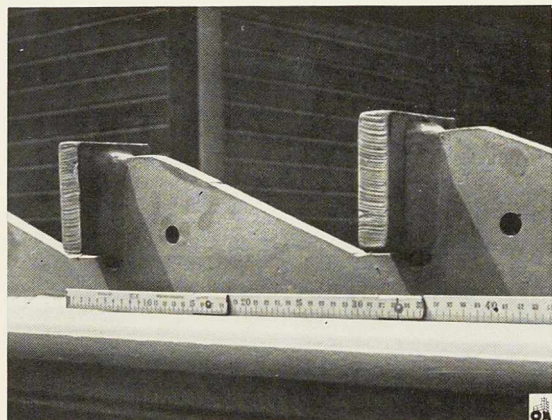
Réalisation de la liaison de la dalle aux poutres.
